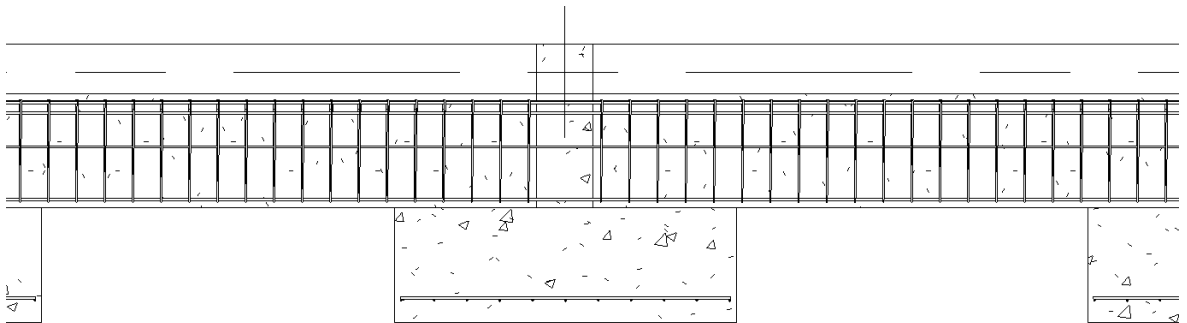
Distribución del acero para las zapatas y vigas de cimentación (Fuente: Elaboración Propia).
